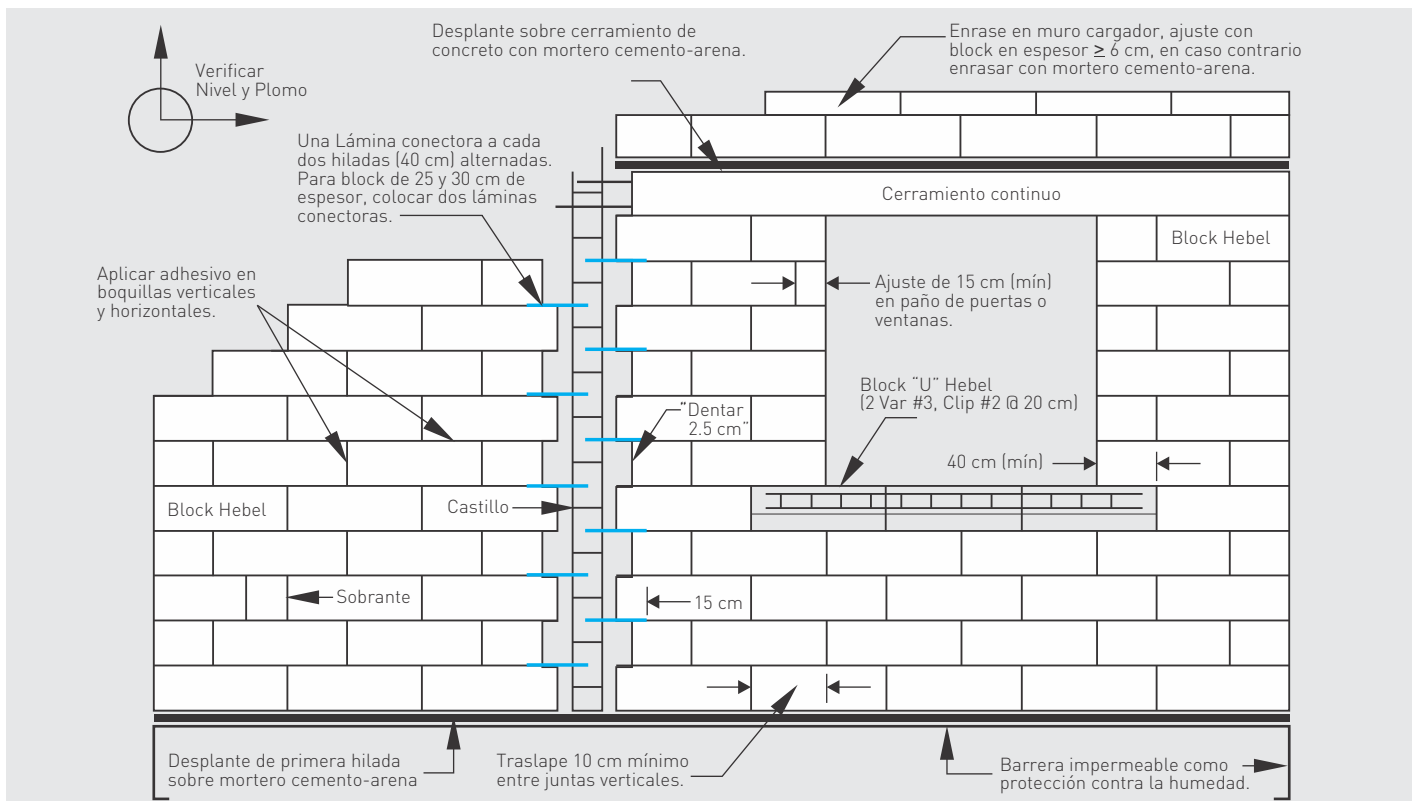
Detalles constructivos para una correcta instalación de block Hebel.
